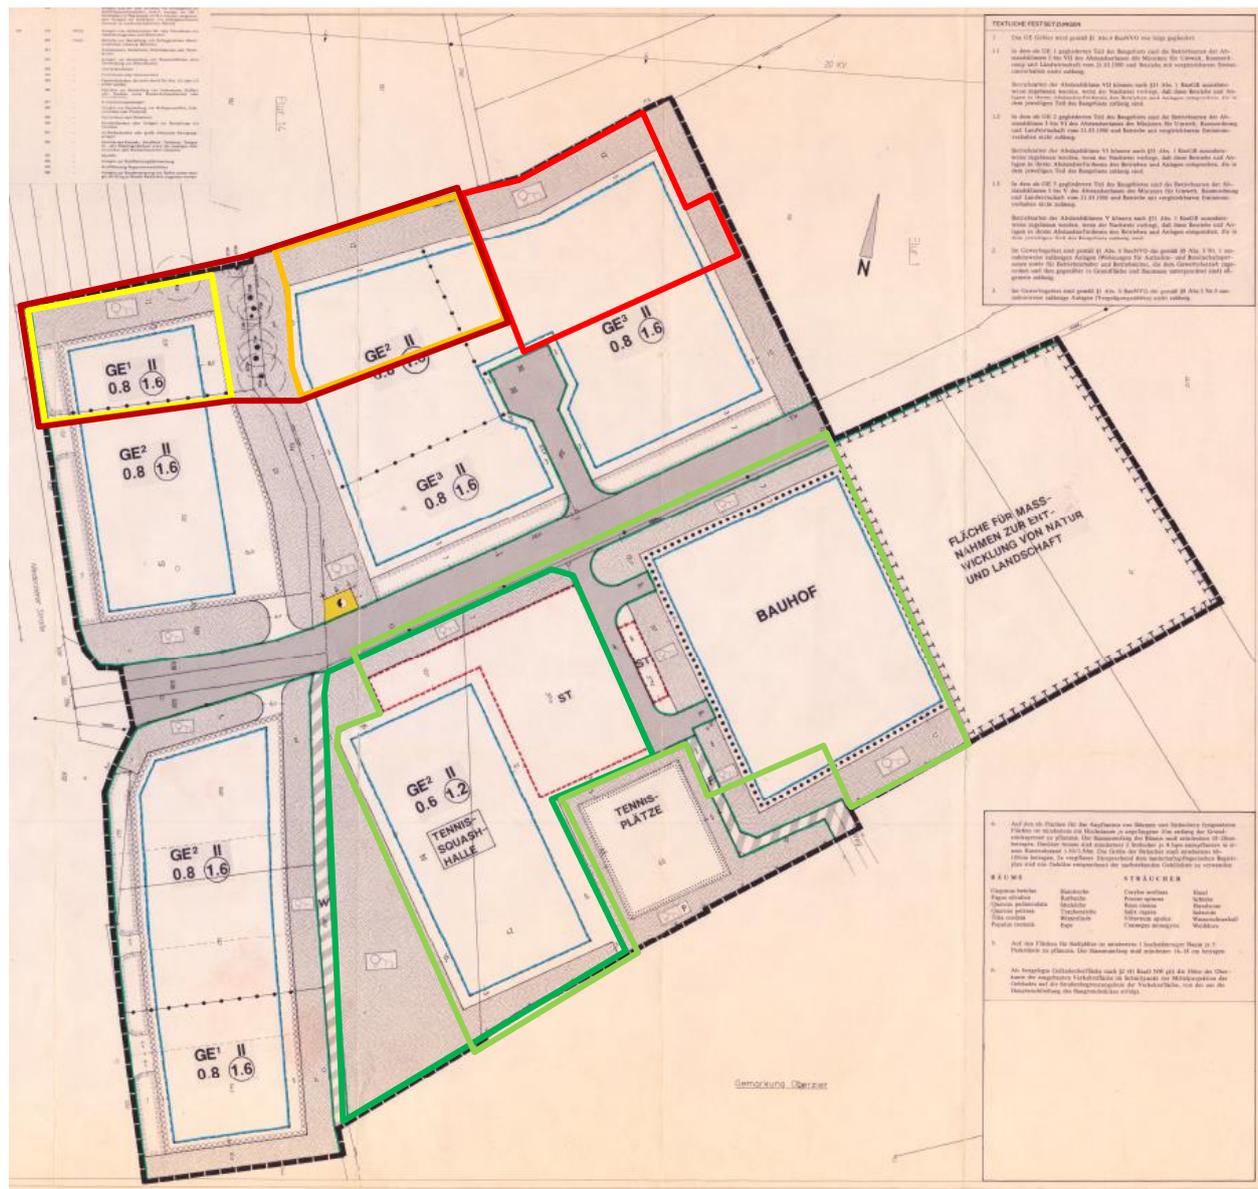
Bebauungsplan B9 in der Ursprungfassung mit Lage der Änderungsbereiche; Quelle: Gemeinde Niederzier
